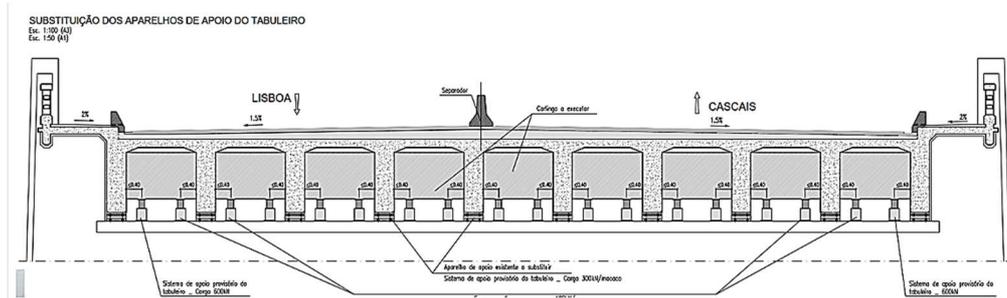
Substituição dos aparelhos de apoio. Apoio provisório do tabuleiro
